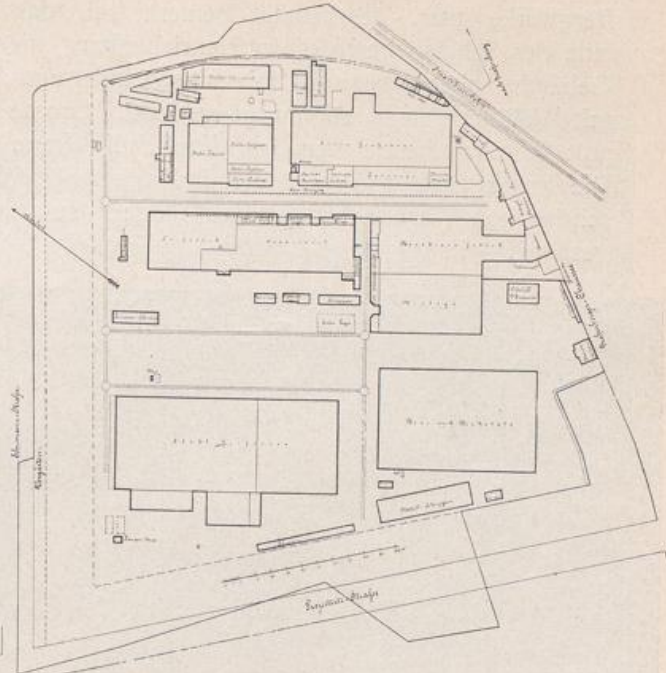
Eisenwerk Haniel & Lueg. Lageplan. 1:4600.
